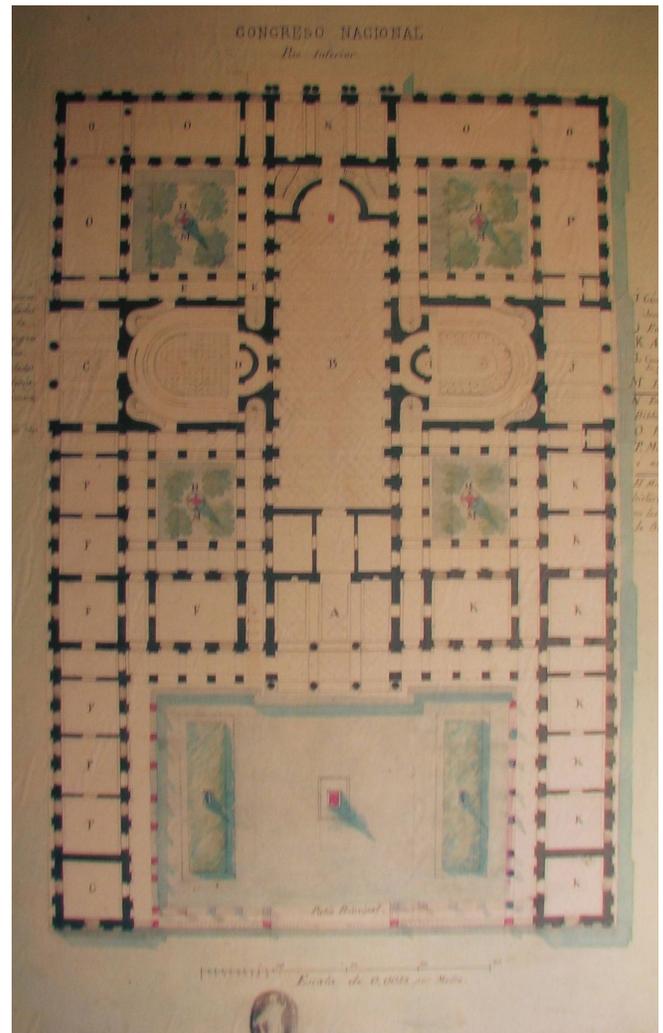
Planta Ex Congreso Nacional Brunet de Baines. Fuente: Archivo DEPA MOP.
